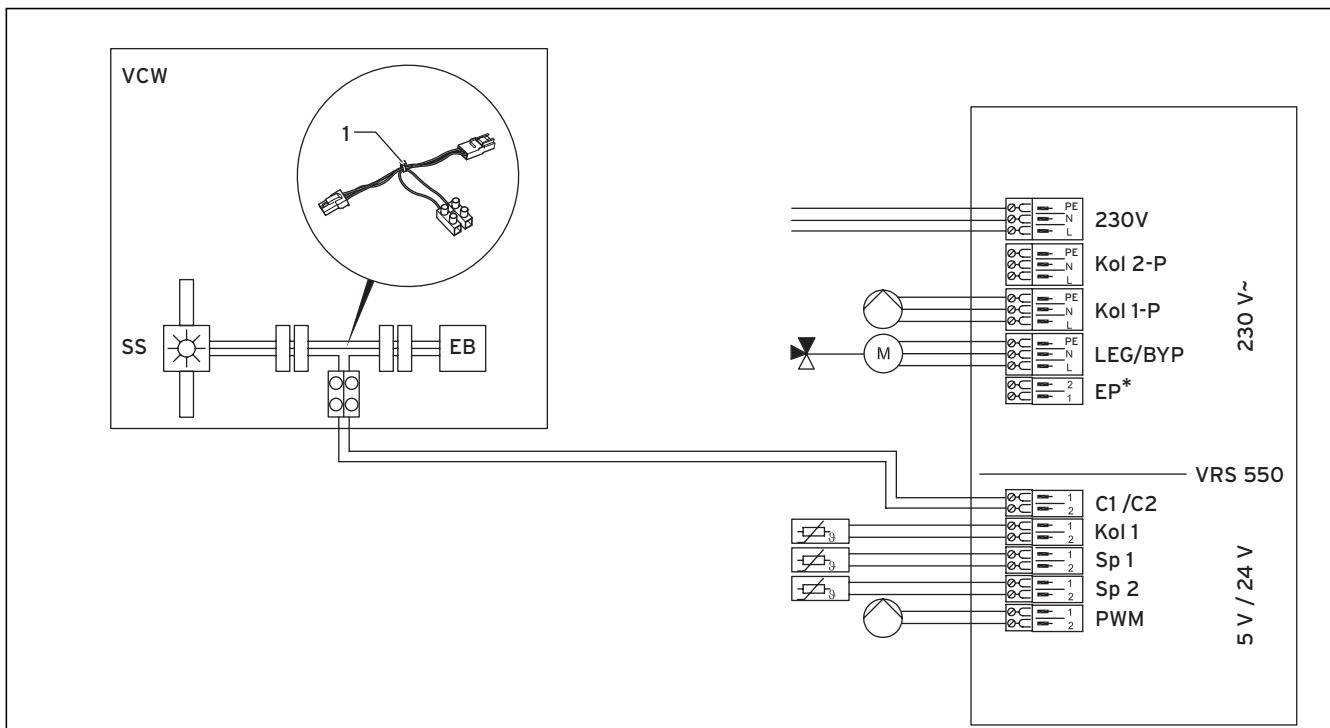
Anschlussplan für Hydraulikplan 1
